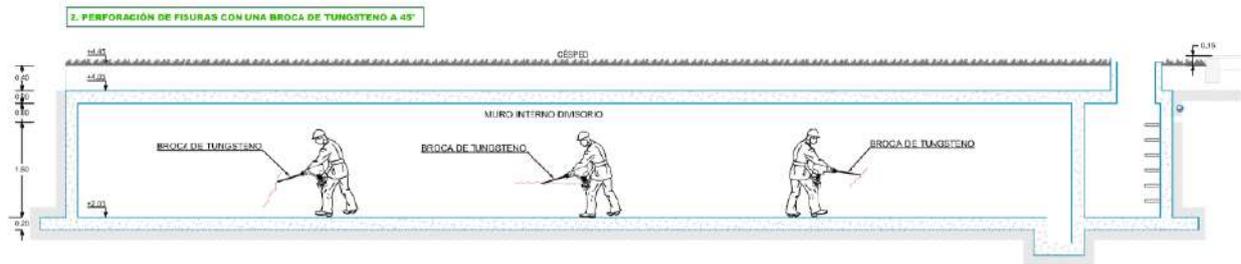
Paso 2. Perforación de fisuras con una broca de tungsteno a 45°
